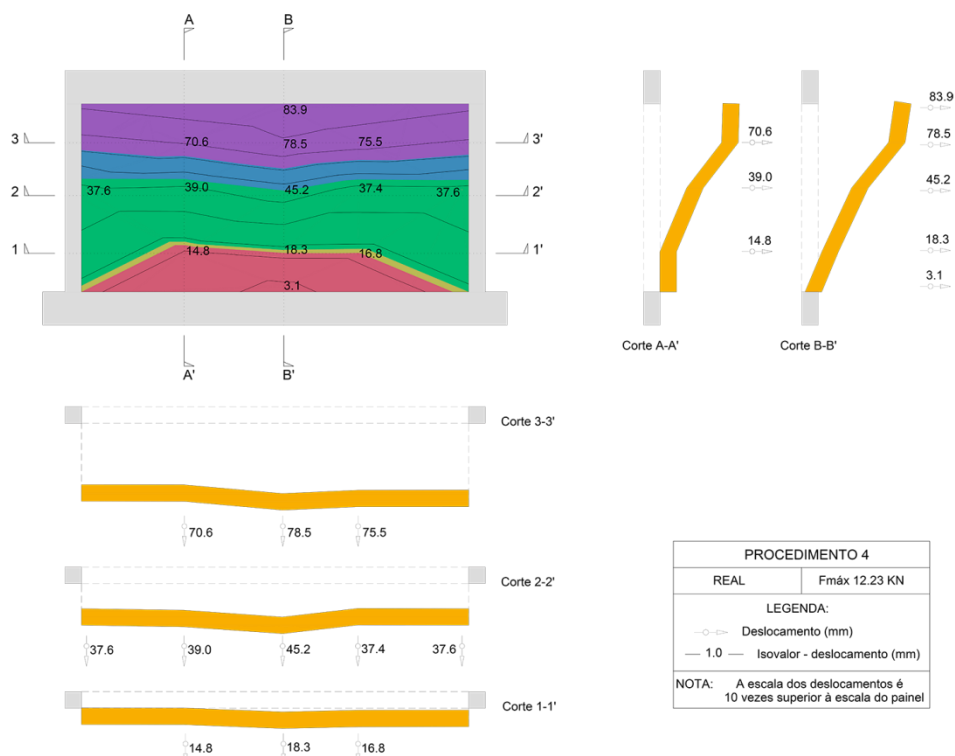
Isovalores da parede ensaiada - Procedimento 4. Ensaio fora do plano, Wall_REF_01.
